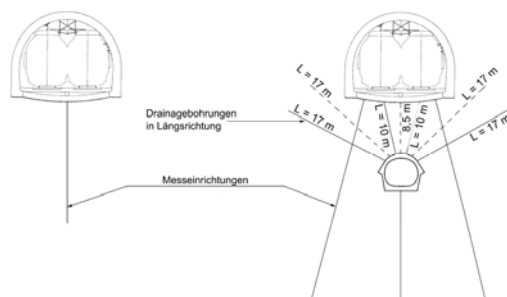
Drainagestollen unterhalb einer Tunnelröhre [36]
